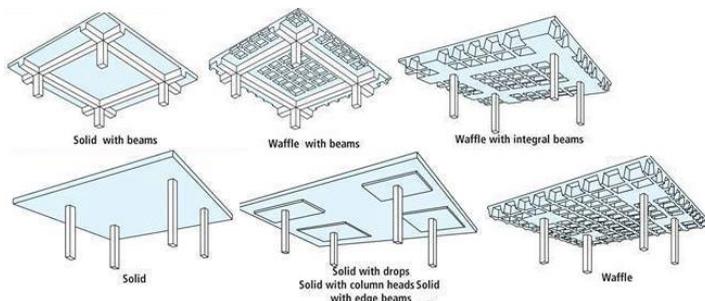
Варианты исполнения двухсторонних плит перекрытий.
